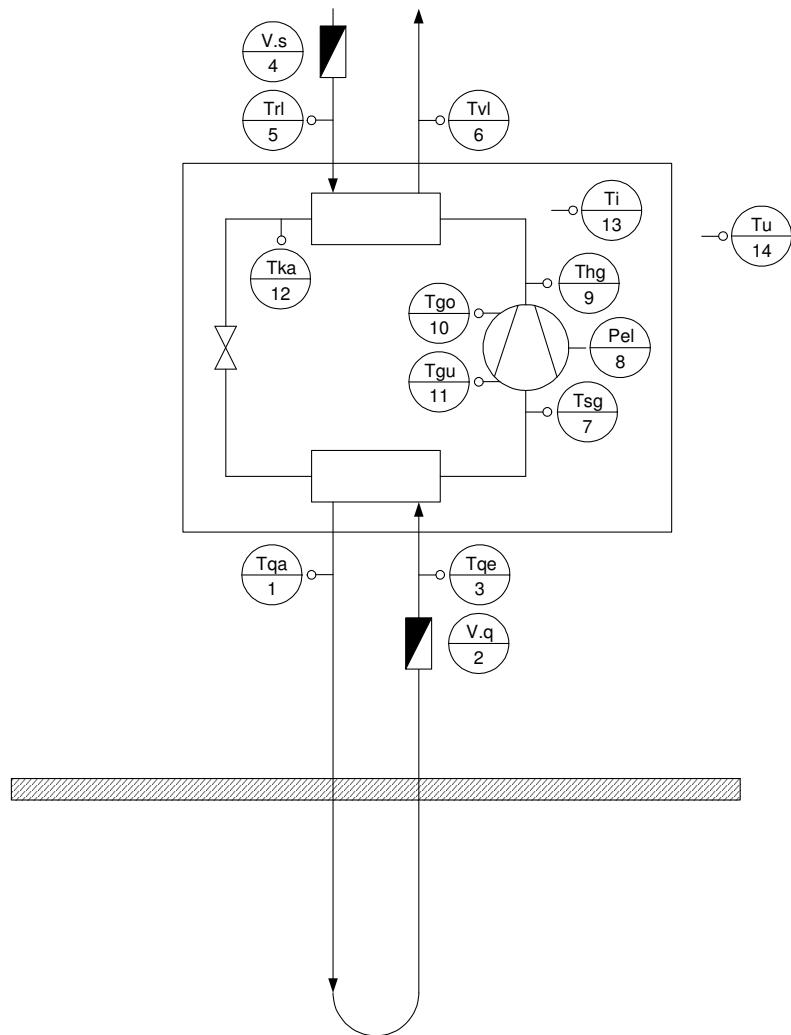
Messstellenplan für die Feldmessung an einer Sole-Wasser Wärmepumpe.
